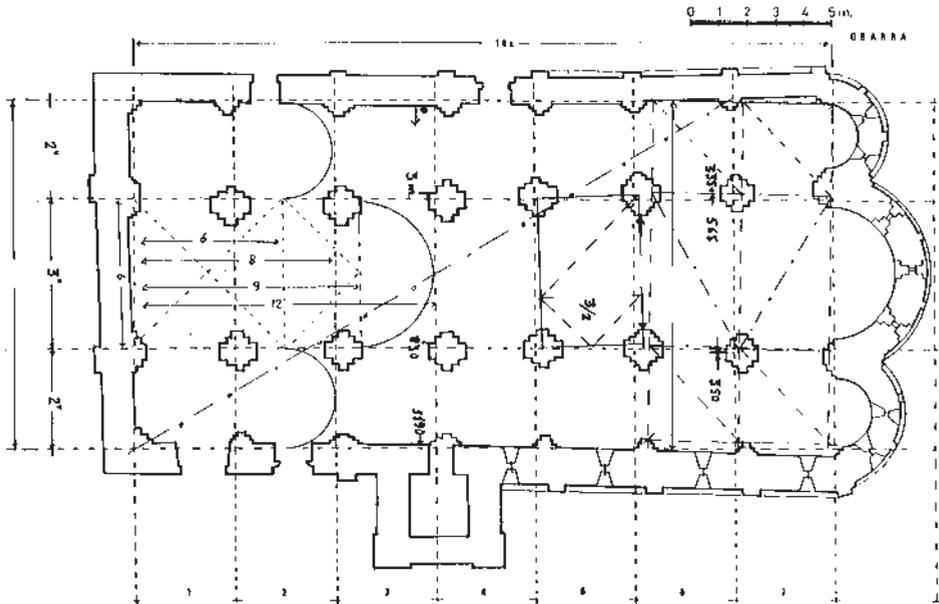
Planta de Santa María de Obarra, superpuesto el esquema de sus espacios y alzado.
